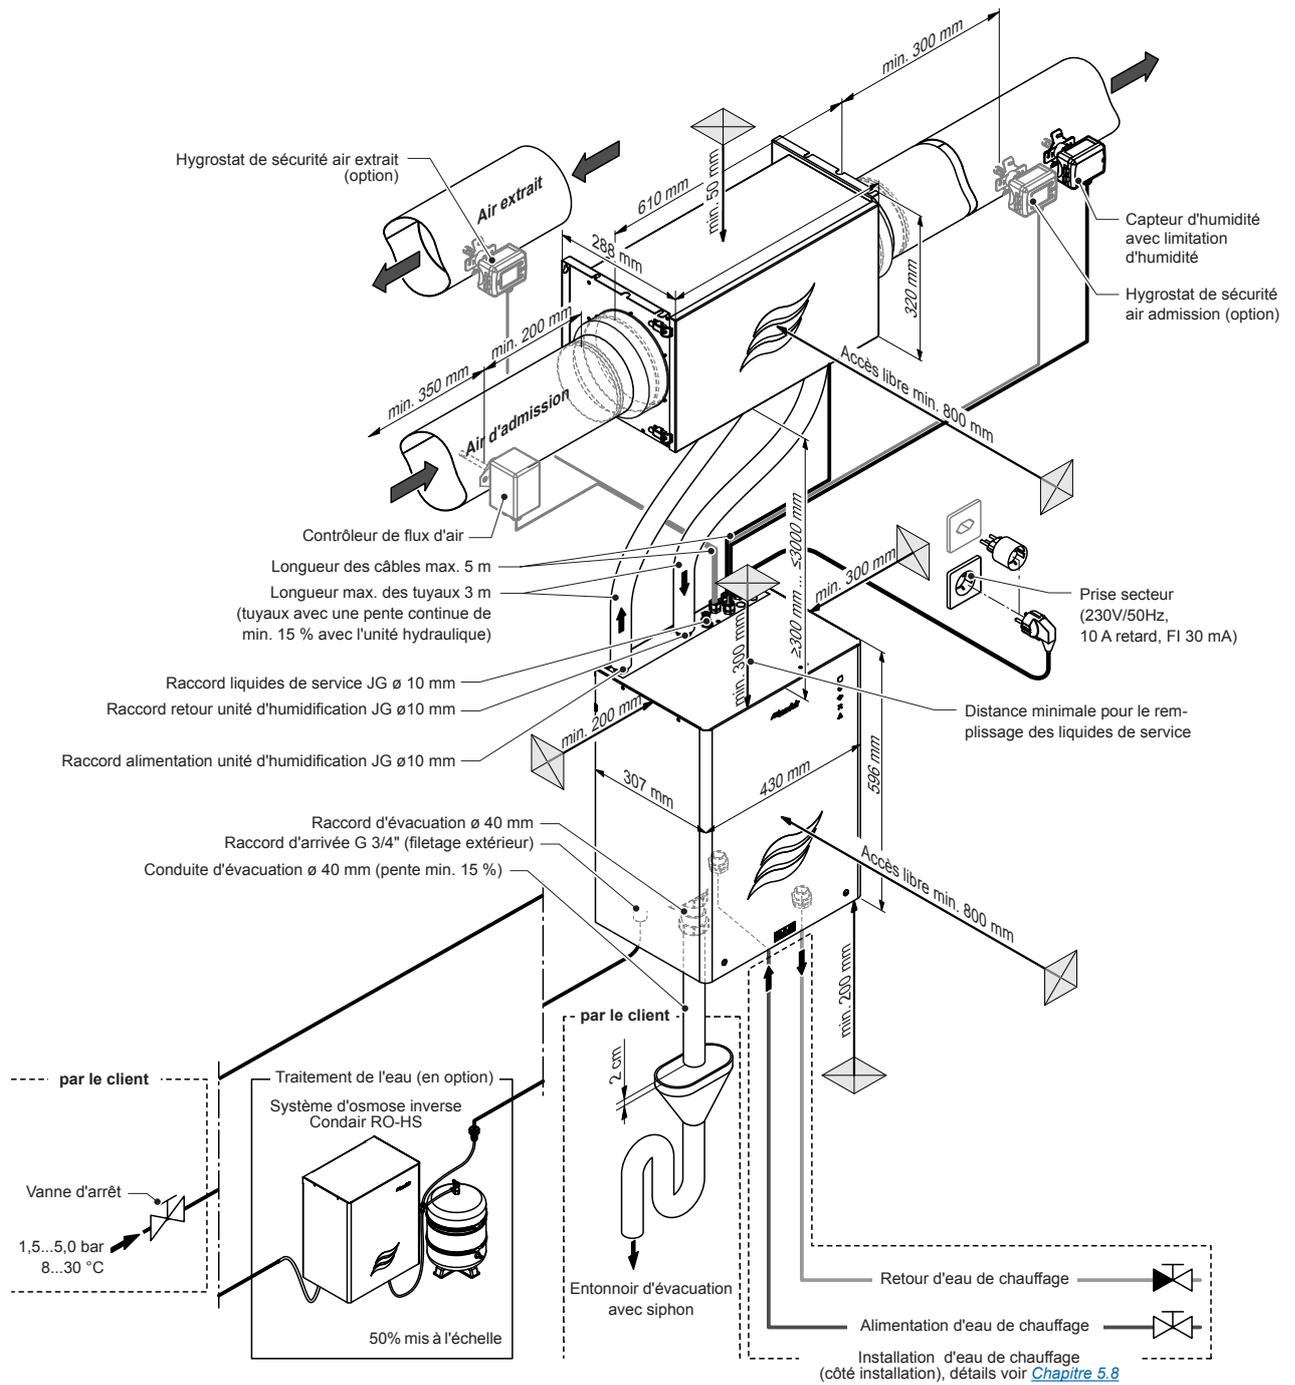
Aperçu de l'installation du Condair MD, variante MD-EL-H
